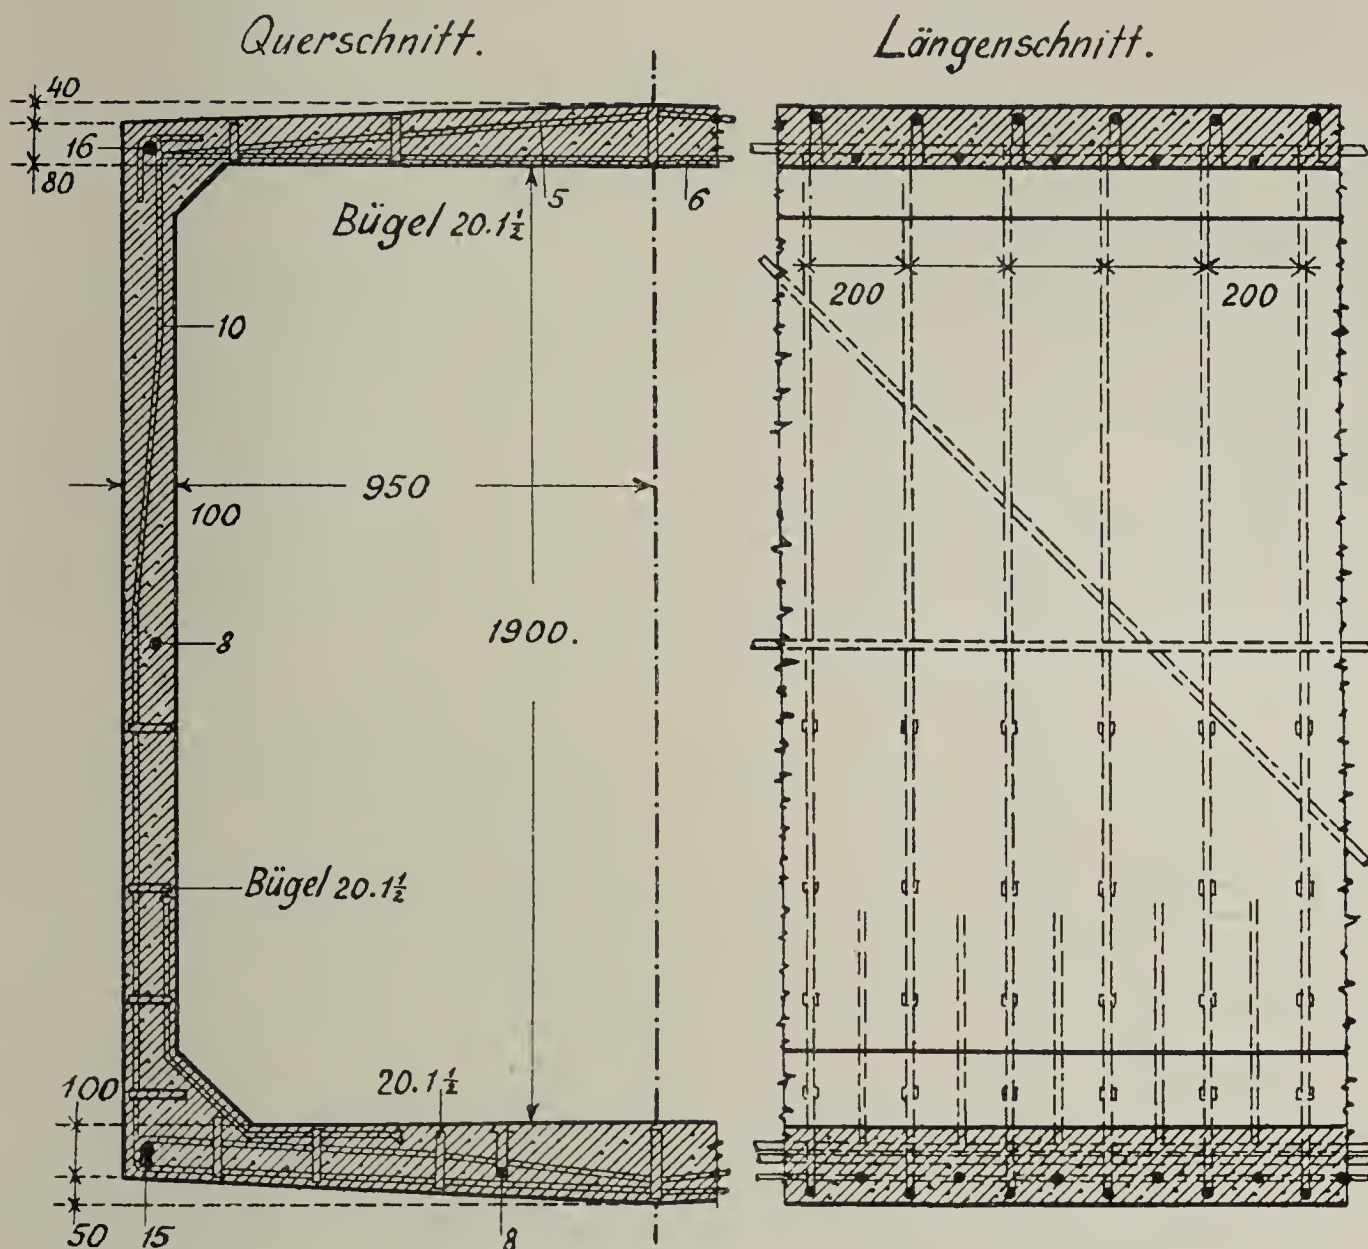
und 263. Wasserkanal beim Bau des Simplontunnels.
